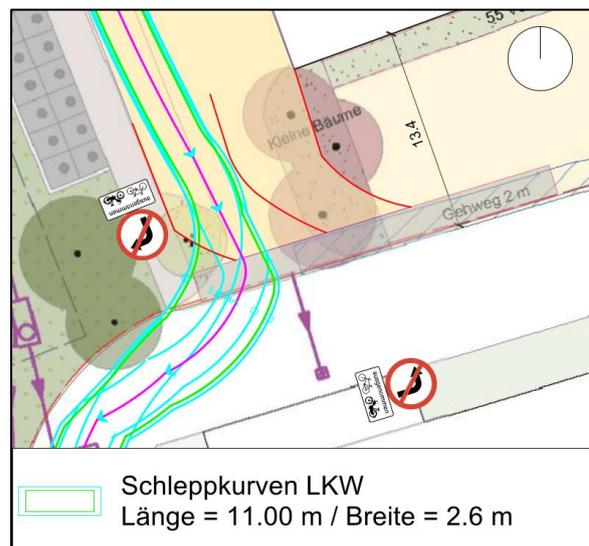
Wegfahrt Müllabfuhr / Baulichtfahrzeug Stufe 1 (Linienführung inkl. Signalisation und Markierung); Grundlagenkarte «Heimberg, Louelipark – Richtprojekt»
